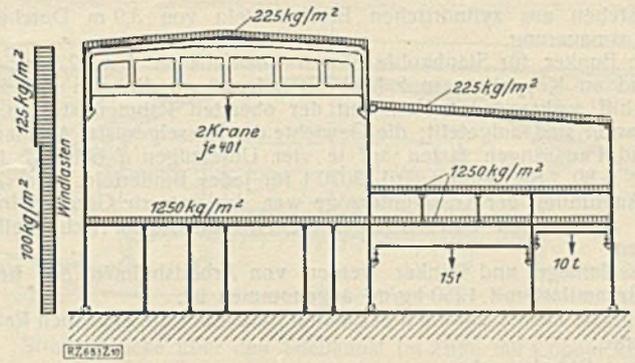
Querschnitt durch Turbinenhaus und Vorbau mit Lasten eines Binderfeldes.
